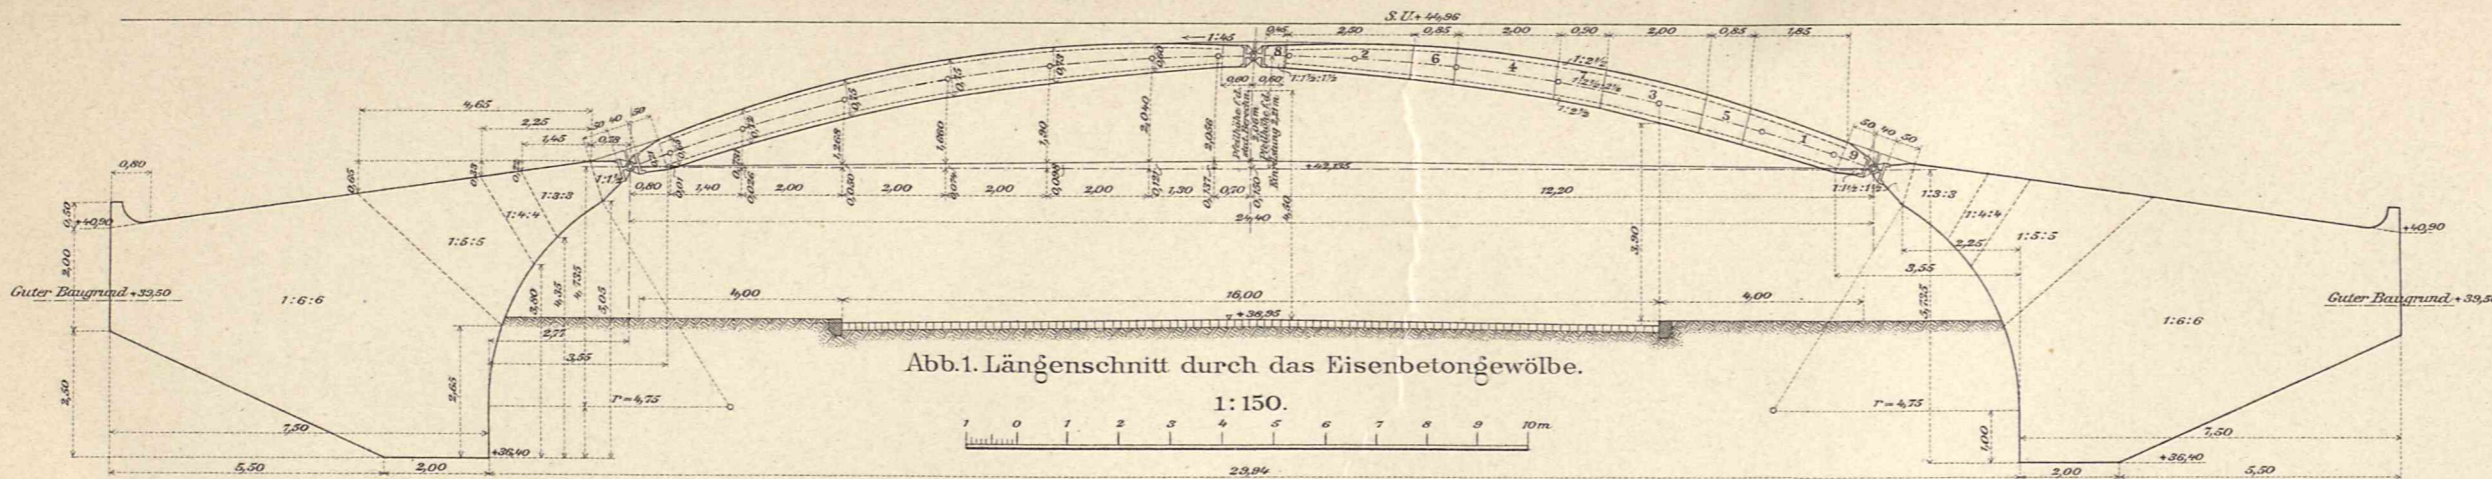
Längenschnitt durch das Eisenbetongewölbe.
